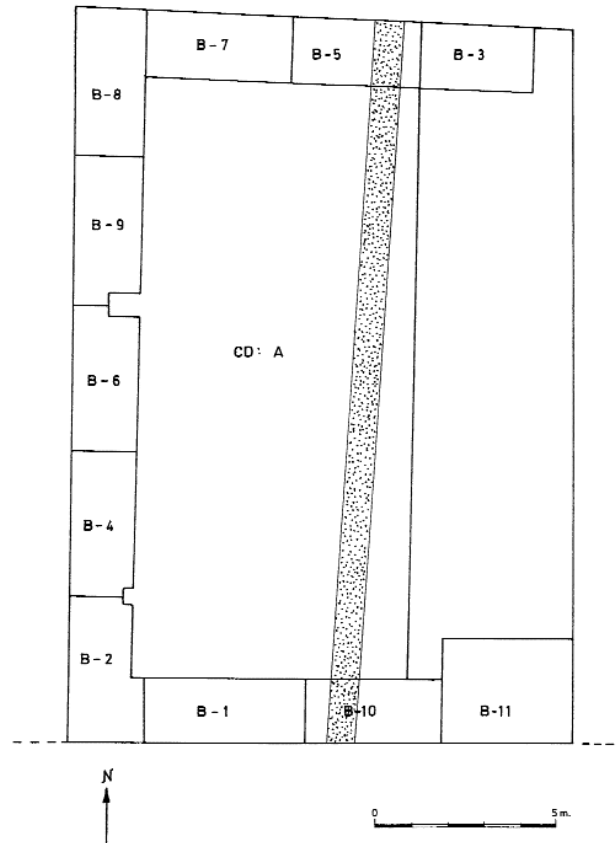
Plano del solar. Excavación en extensión y ejecución de bataches.
